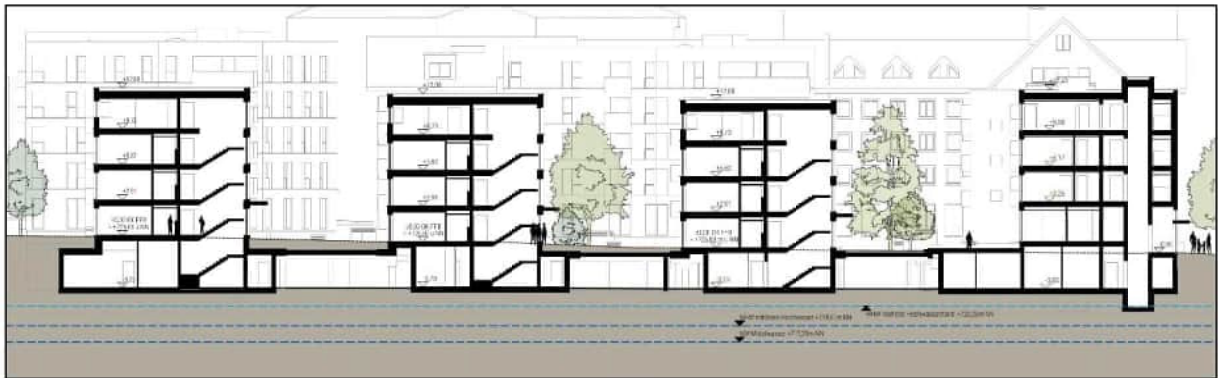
Schnitt - Grundwasserstände (Plan: FG Architekten, 2023)
